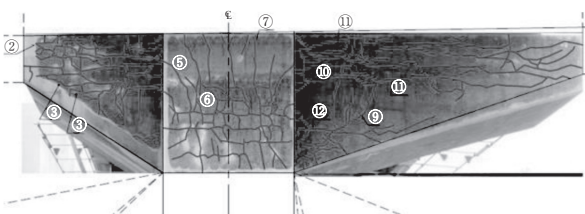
東下 P44 梁部のひび割れ状況
